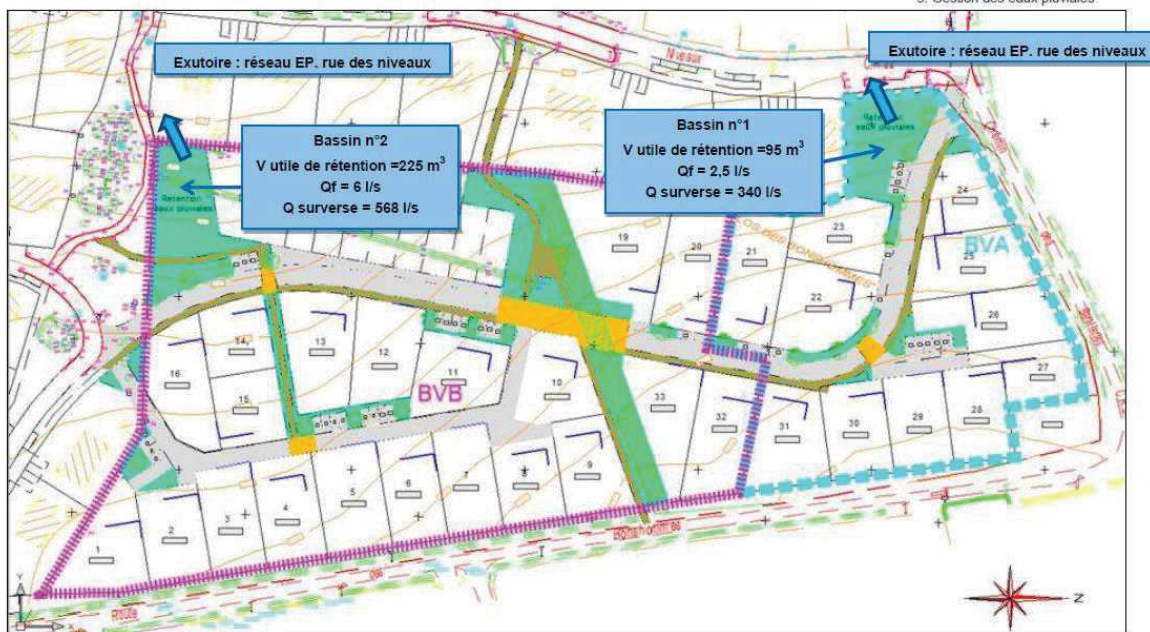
Schéma du dispositif d'assainissement des eaux pluviales
